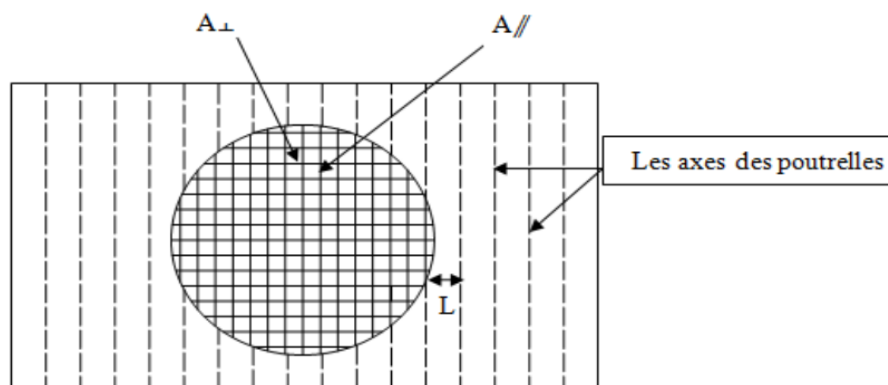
Dessin de ferrailage des poutrelles de terrasse
